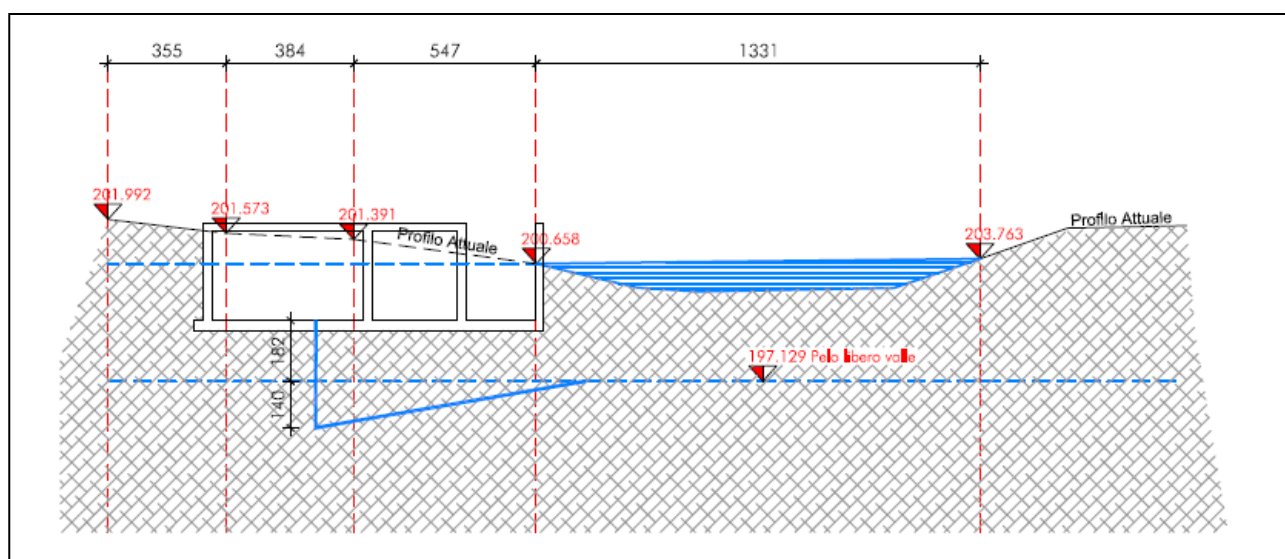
Sezione del locale centrale con vista a valle della briglia con il vano di alloggiamento della turbina e lo scarico di restituzione delle acque turbinate
